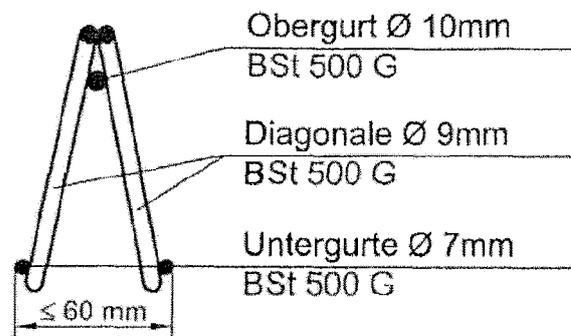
Schnitt durch FILIGRAN - Durchstanzbewehrung
